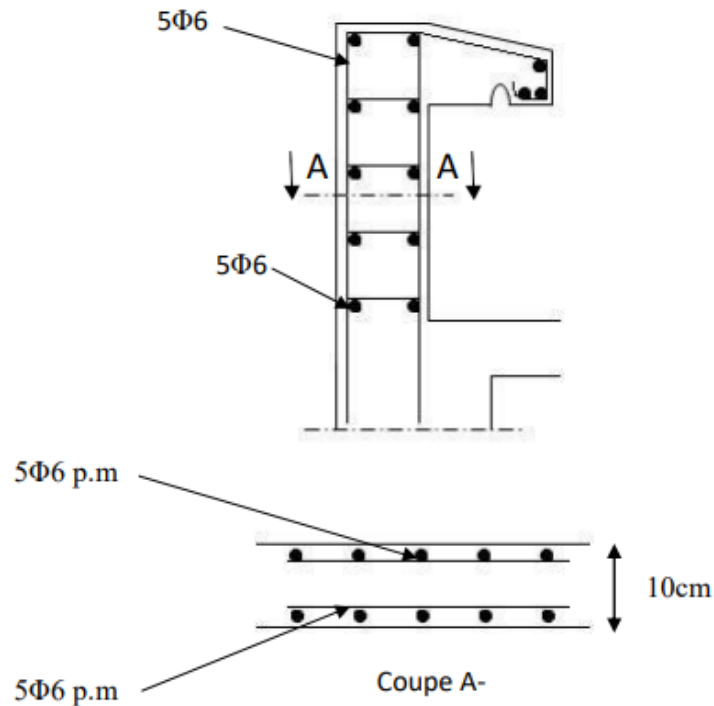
Disposition du ferrailage de l'acrotère.
